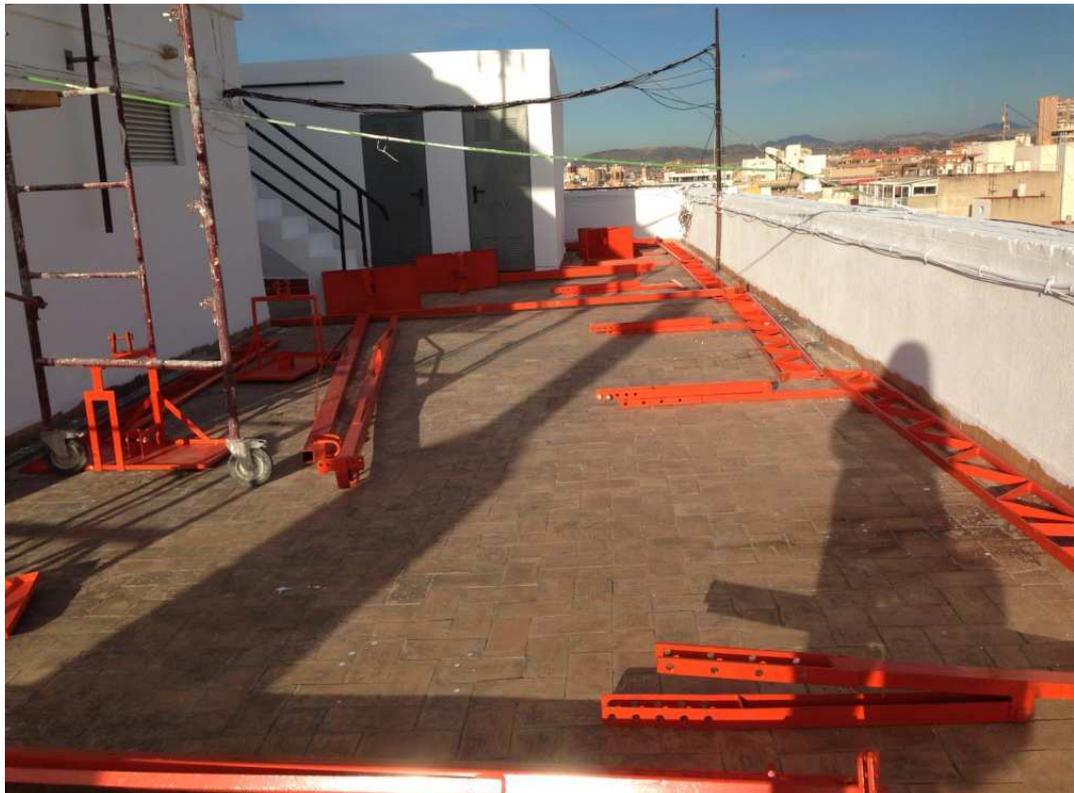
Replanteo de elementos sobre cubierta. Fuente: Elaboración propia.
